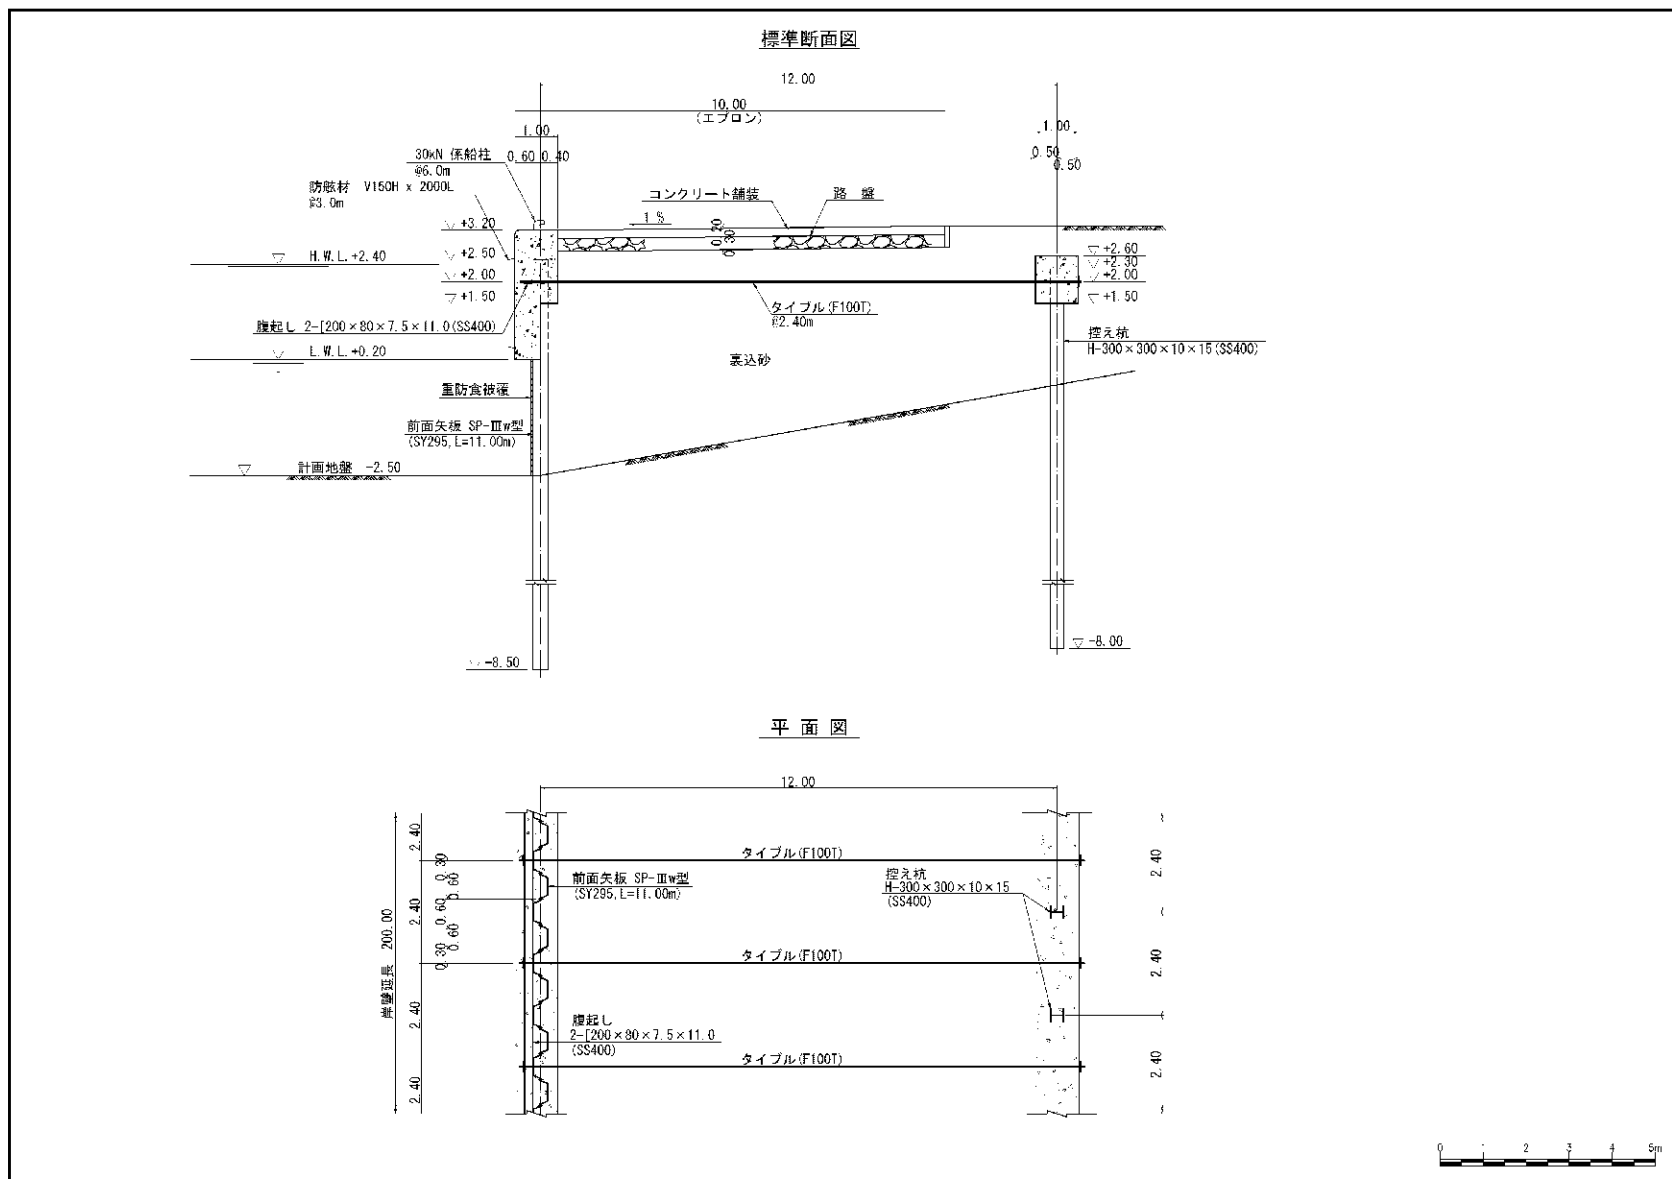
(16) 埠頭（岸壁）の標準断面図
